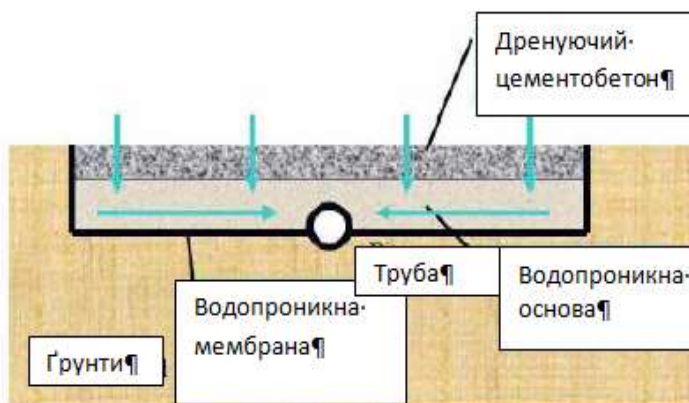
Схема внутрішнього водовідведення з проникного покриття із дренажного бетону
